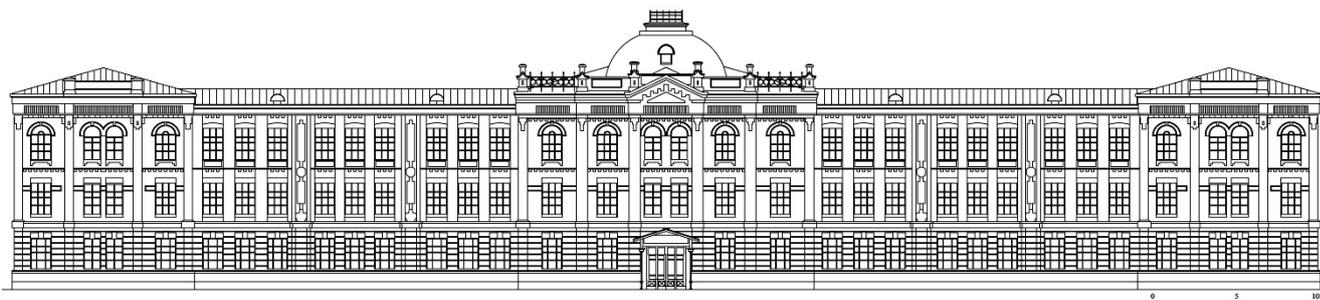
Здание кадетского корпуса, фрагмент уличного фасада (реконструкция)
